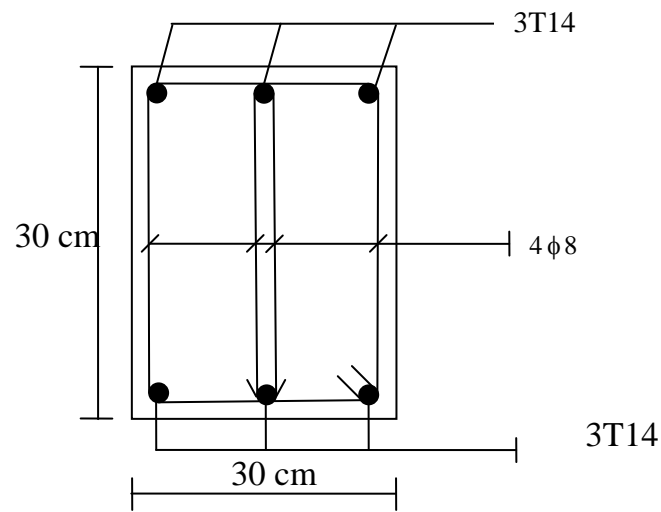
Schéma de ferrailage de la poutre Secondaire (Travée)
